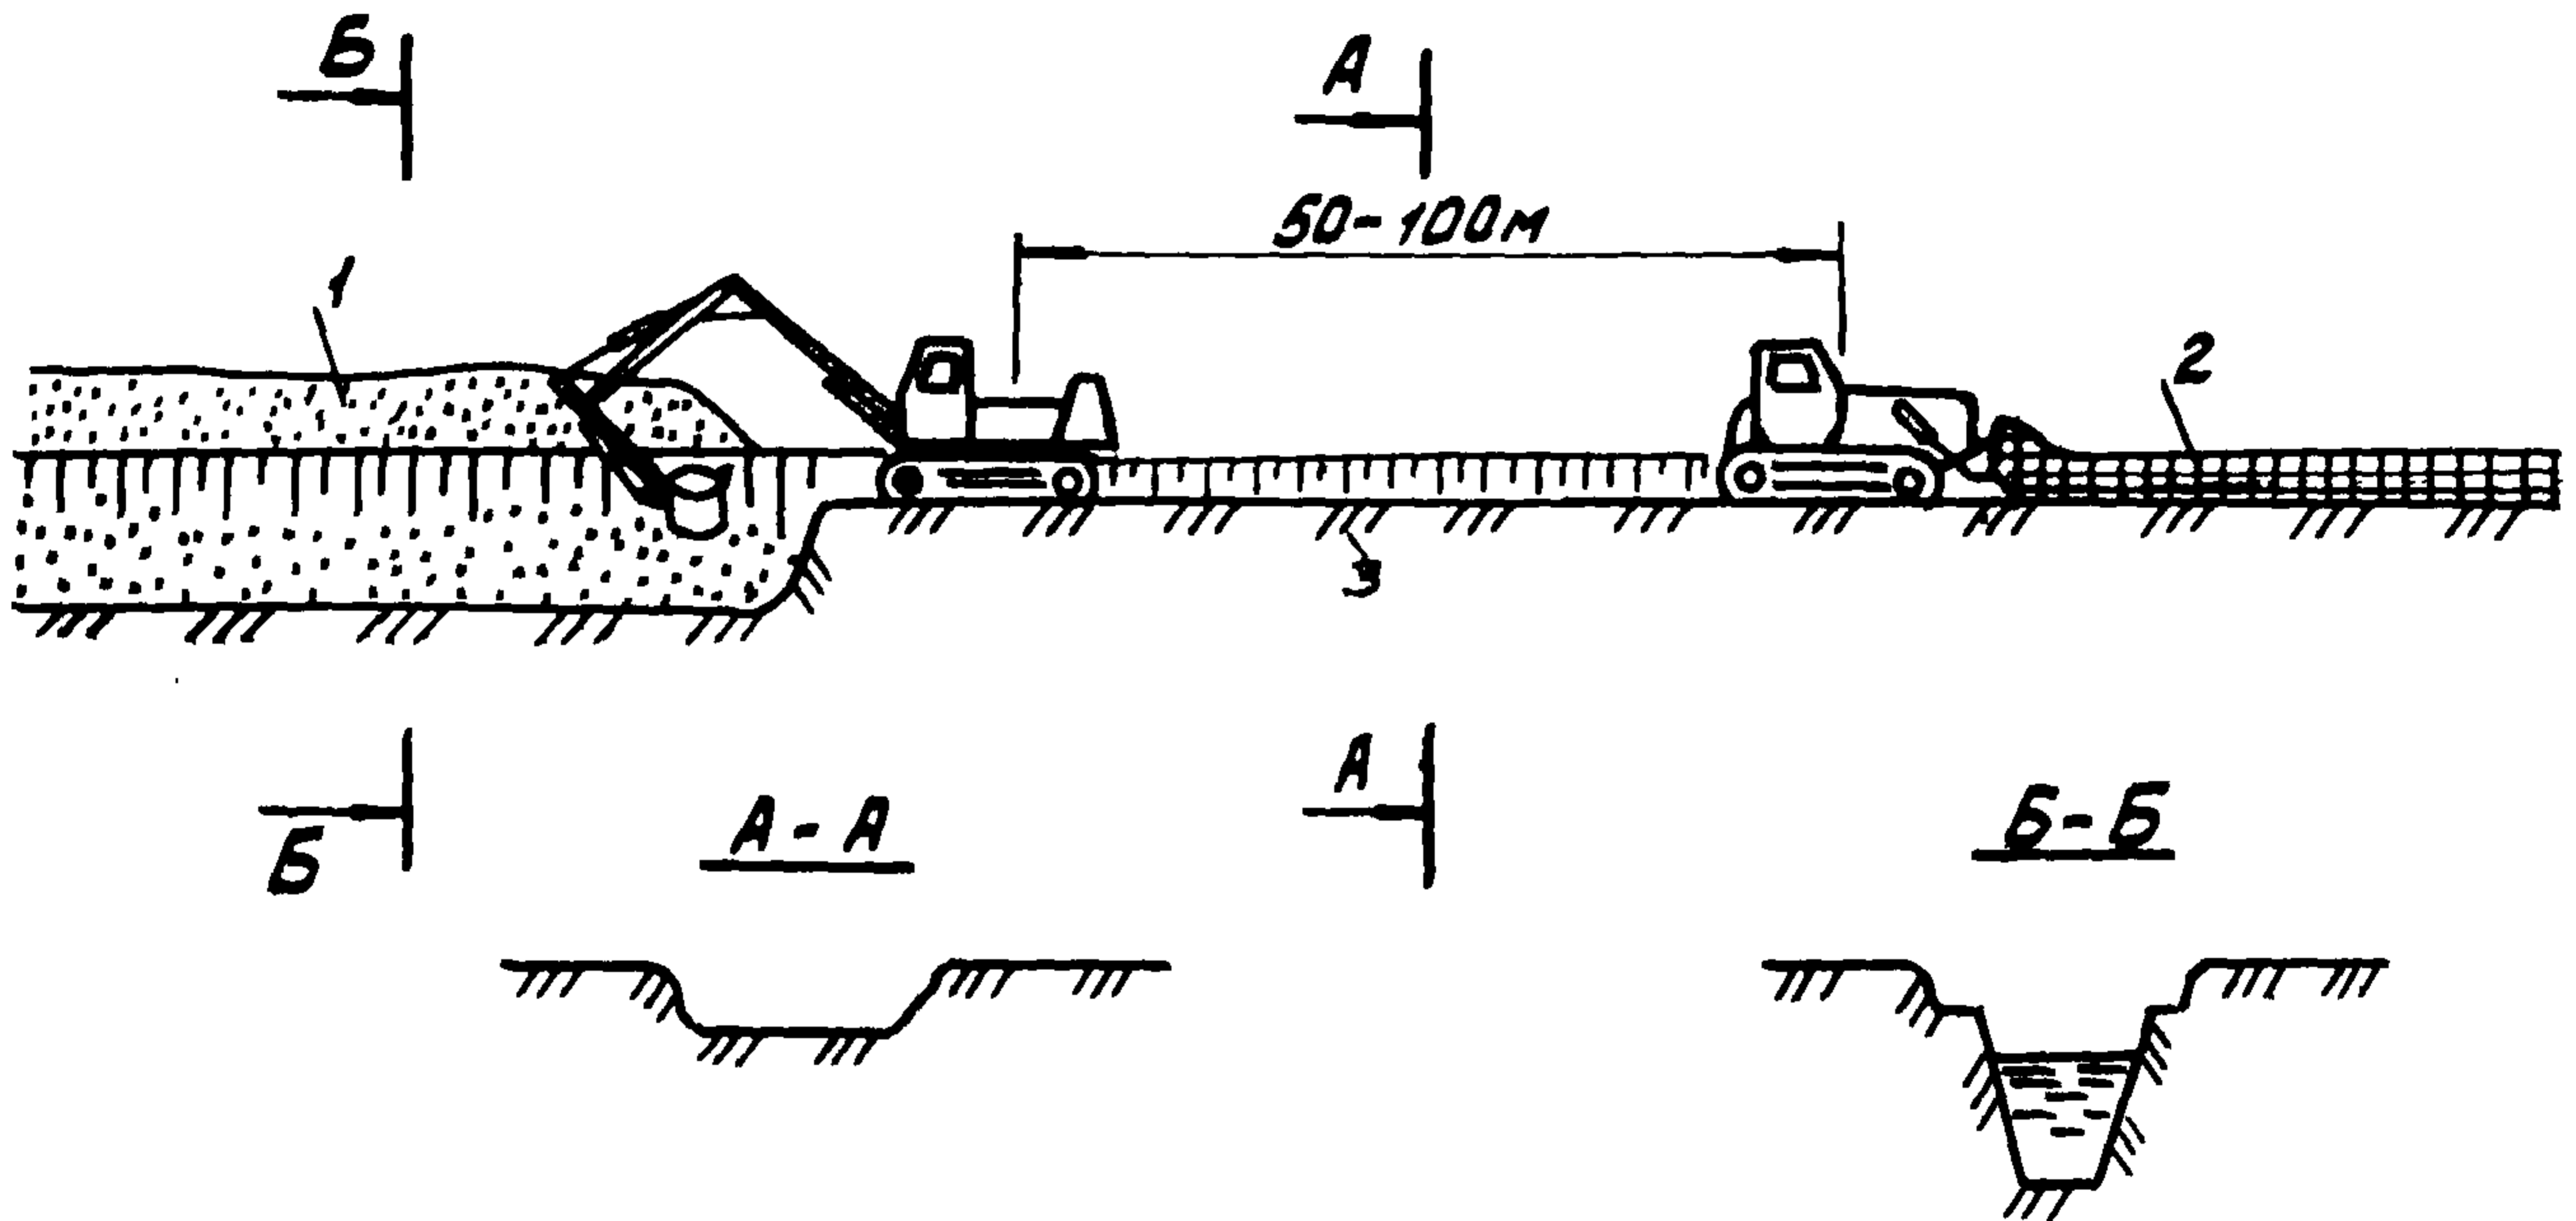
Разработка траншей на болоте с несущим подстилающим основанием, с предварительным выторфовыванием с помощью бульдозера:
